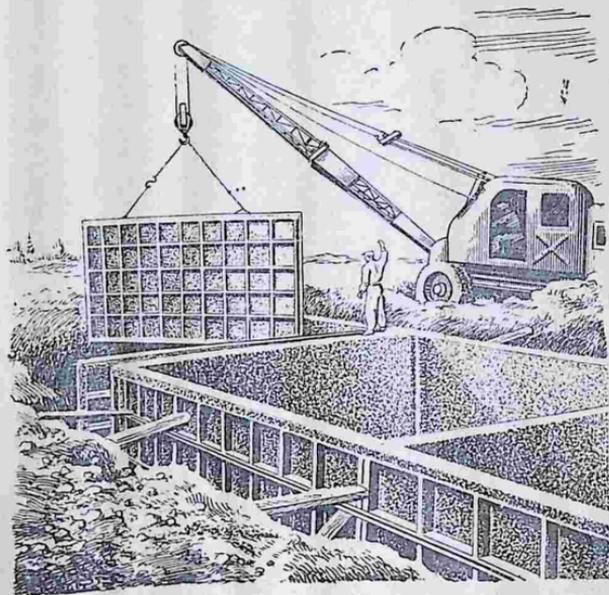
Силосные траншеи из сборных железобетонных ребристых плит.
